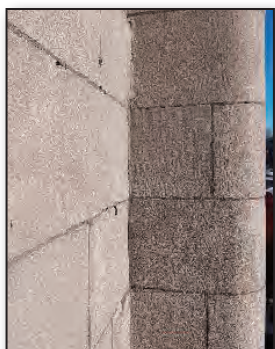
Mur de pierres lisses avec avancée en arrondi.
